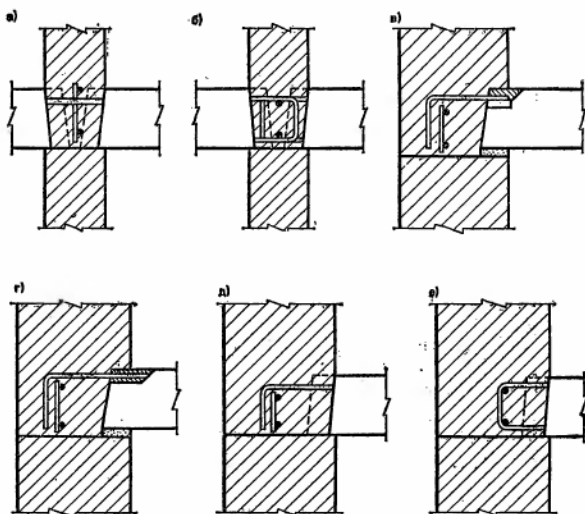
Комбинированные узлы монолитных стен со сборными сплошными плитами перекрытий
